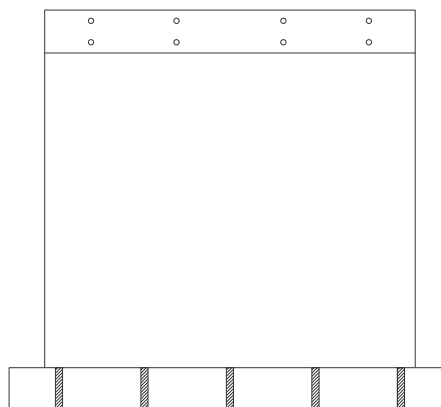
Ningún agrietamiento de muro de albañilería confinada con ladrillos pandereta industrial en la distorsión 1/4200.
